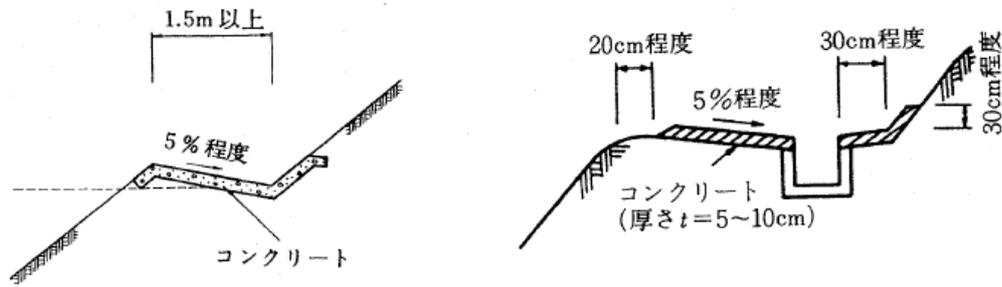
コンクリート排水溝及び鉄筋コンクリートU形溝の例（小段排水）
